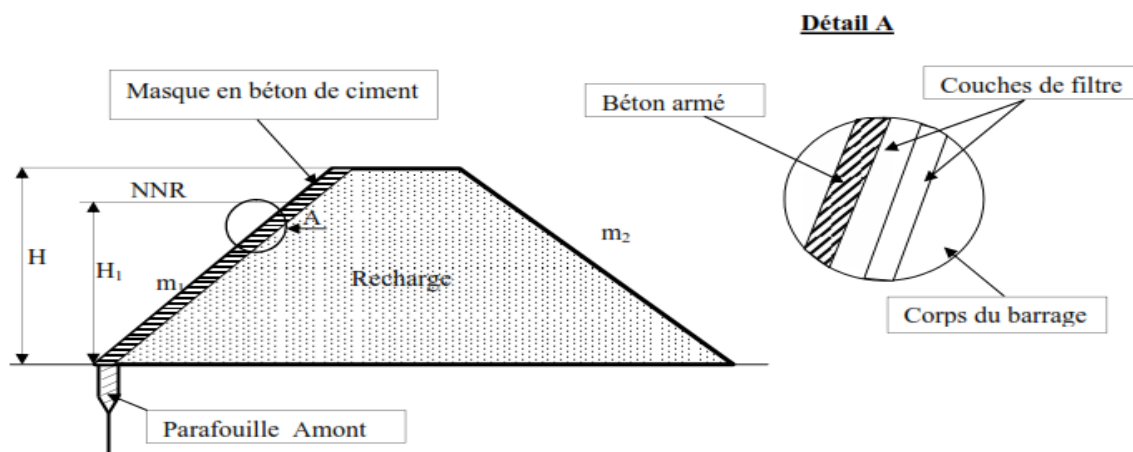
Coupe transversale d'une digue en enrochement avec masque en béton
